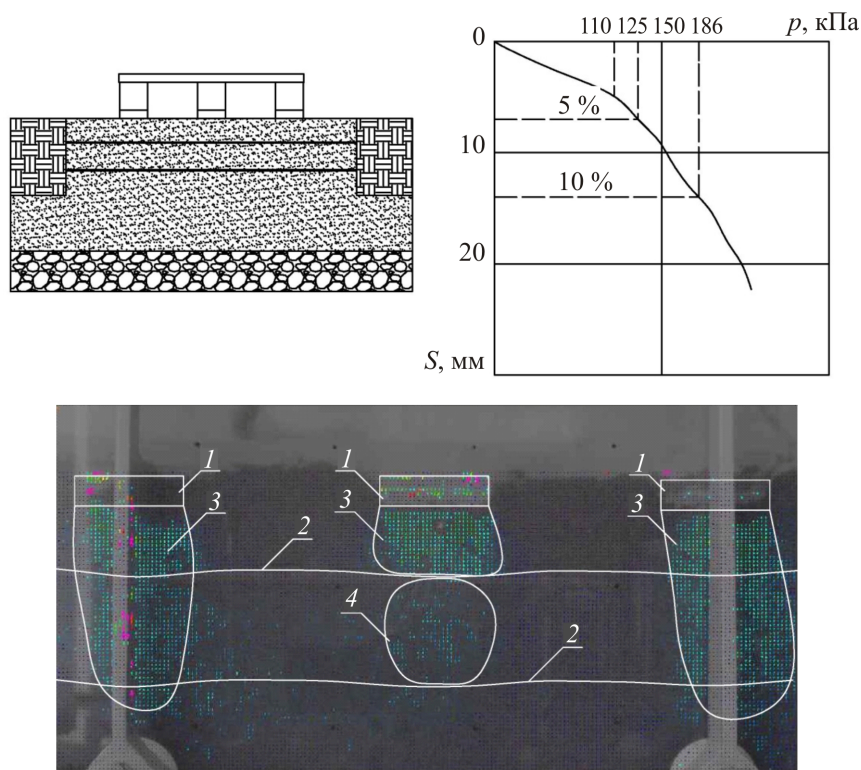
Двухслойное армирование без предварительного напряжения: 1 – штампы; 2 – слои армирования; 3 – зоны средних перемещений; 4 – зоны минимальных перемещений частиц песка
